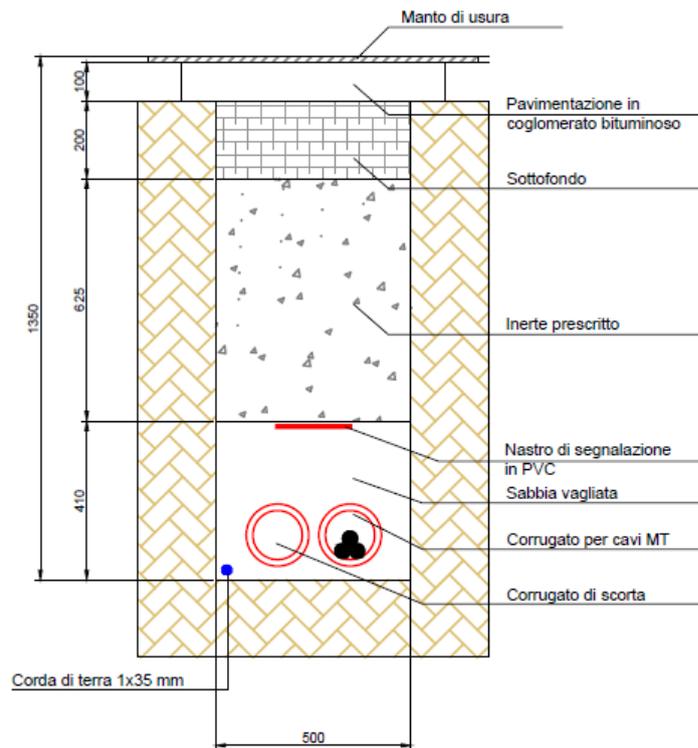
Sezione tipica di posa della linea in cavo su sede stradale
